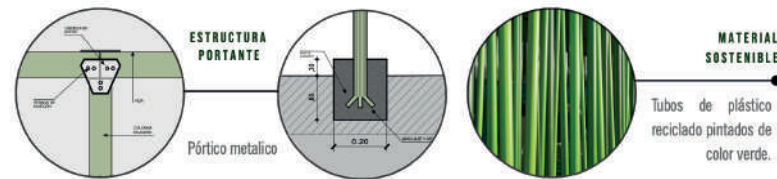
▶ Detalles constructivos y materiales propuestos.
